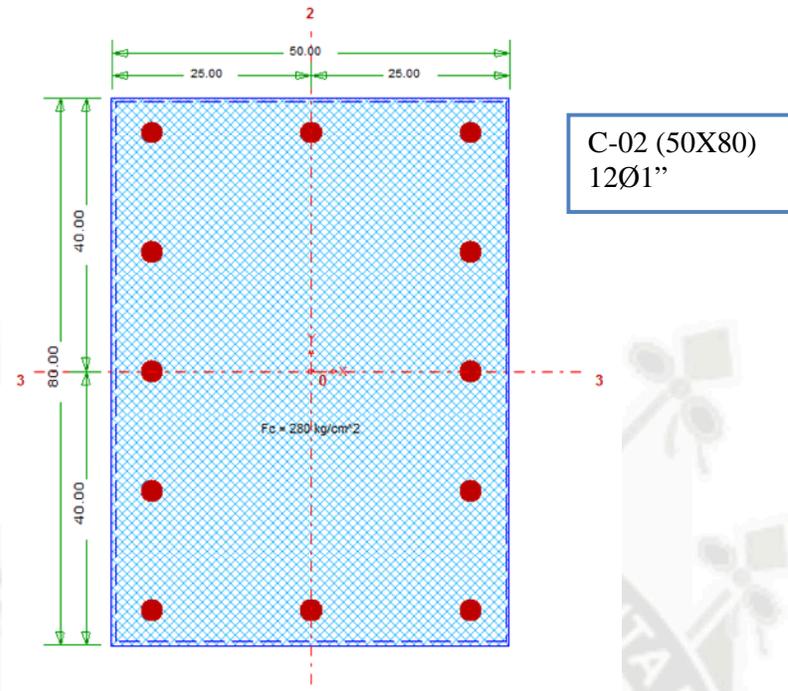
Sección de la Columna a Diseñar 50x80.
